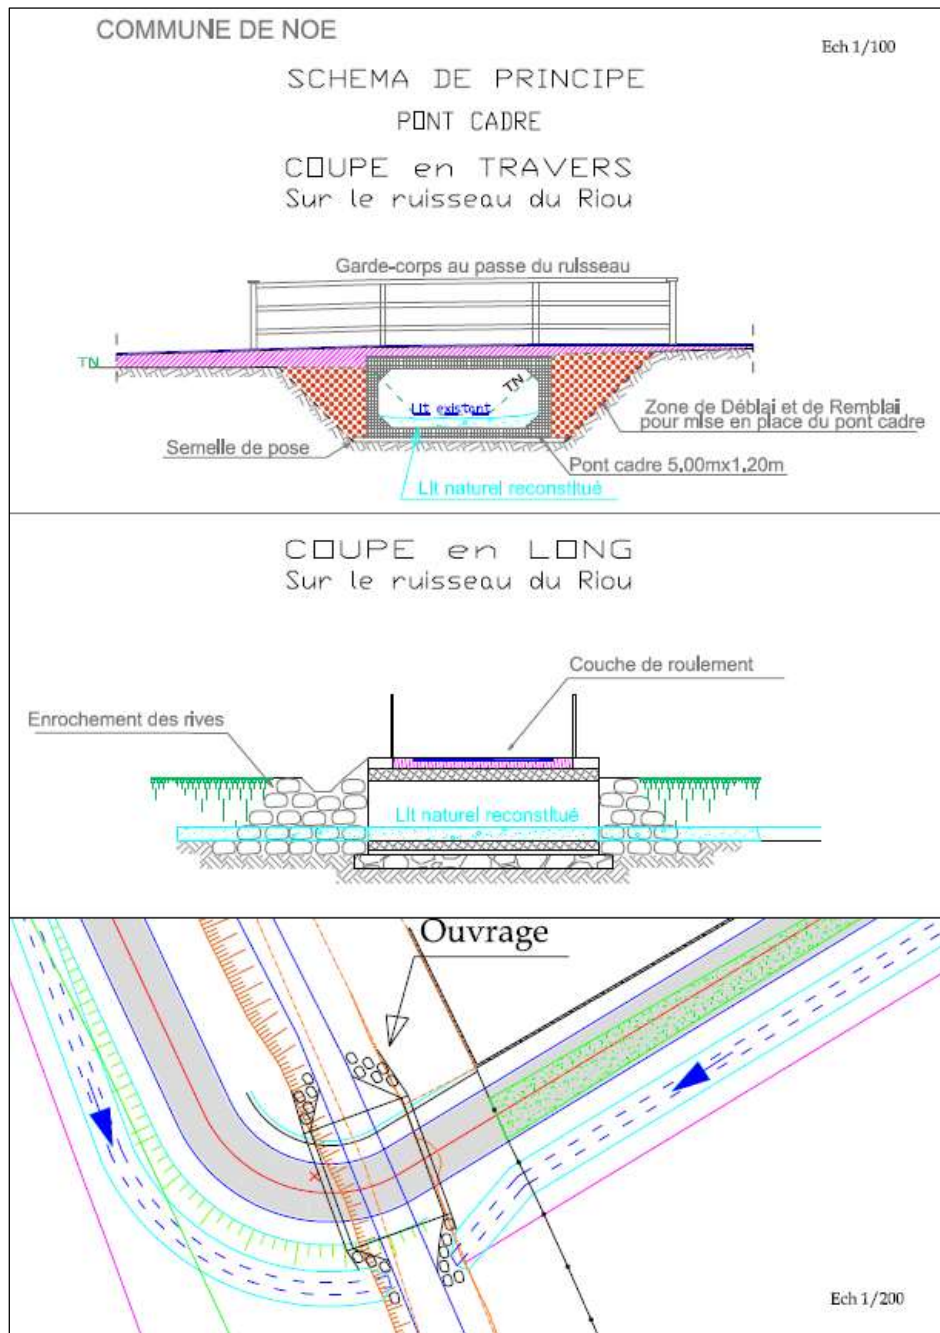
Coupes et plans de l'ouvrage de franchissement du Riou
